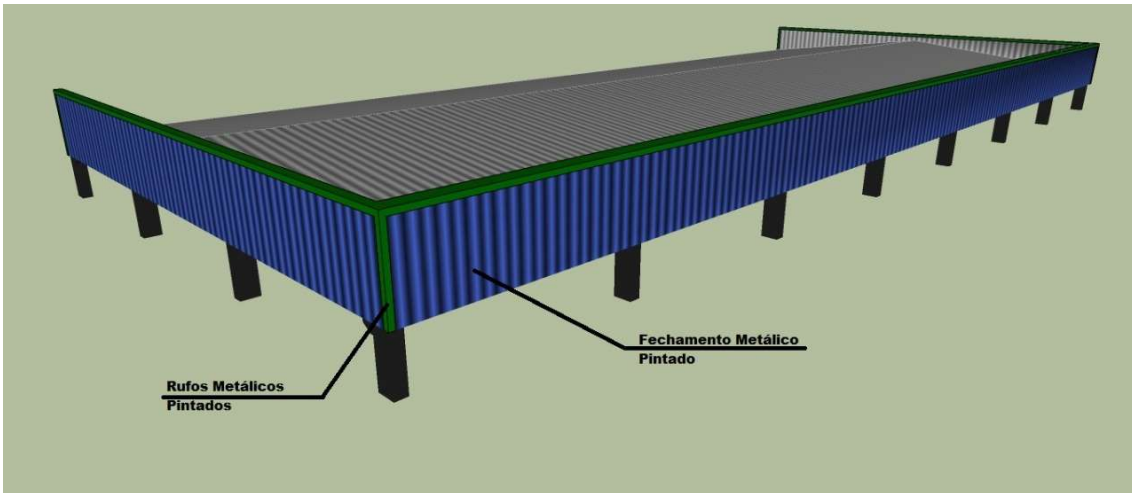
Nova cobertura completa vista frontal e lateral leste
